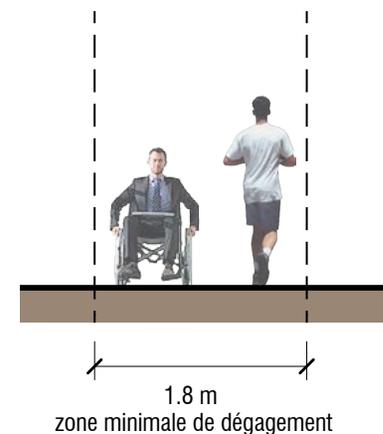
1,8 m est la zone minimale de dégagement pour les piétons sur un trottoir du centre-ville
